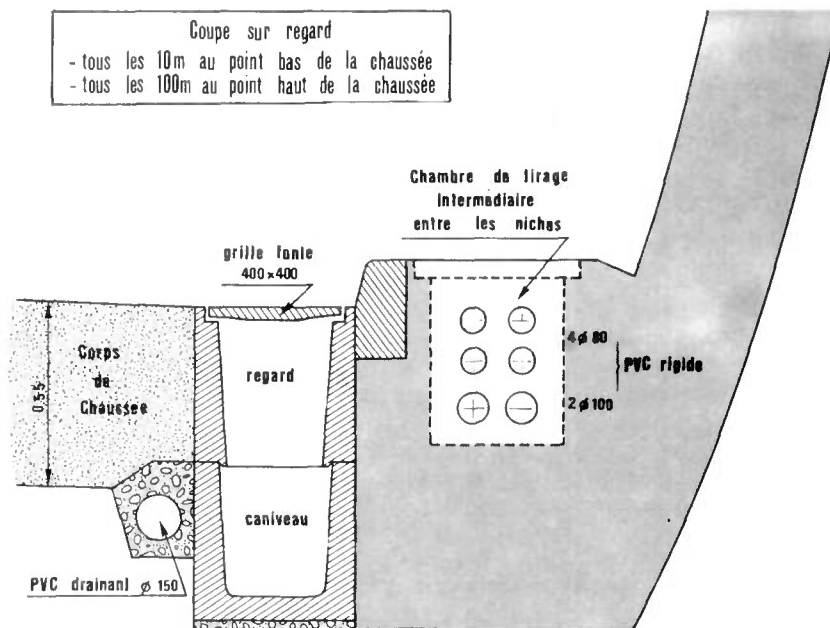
Autoroute A 40 - Tunnel de Chamoise. Aménagement type des banquettes
